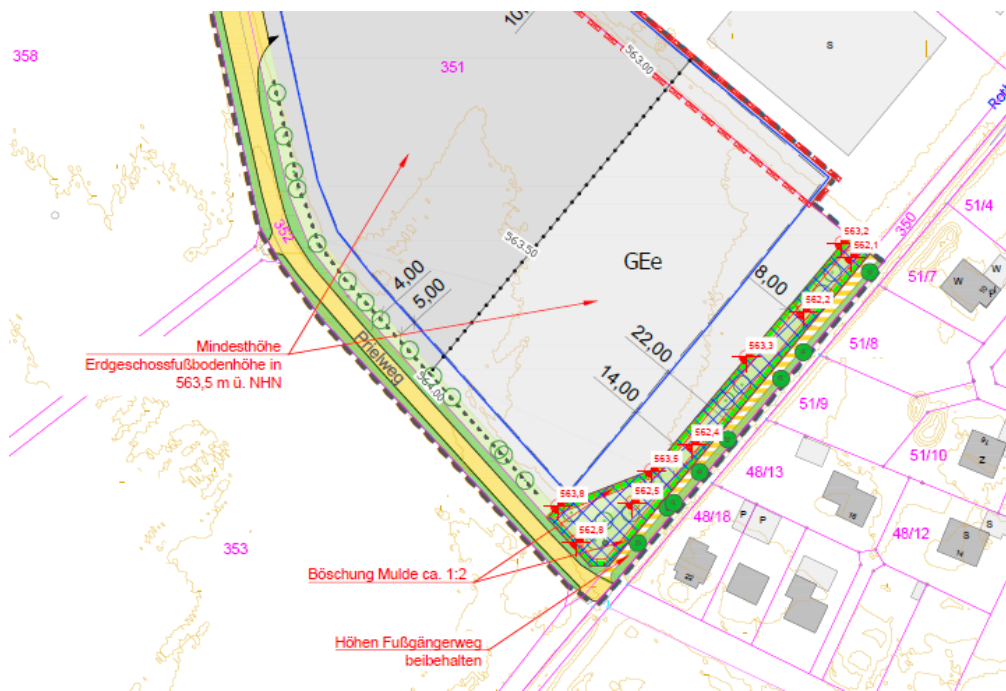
Maßnahmenvorschläge Lageplan siehe Anlage 2
